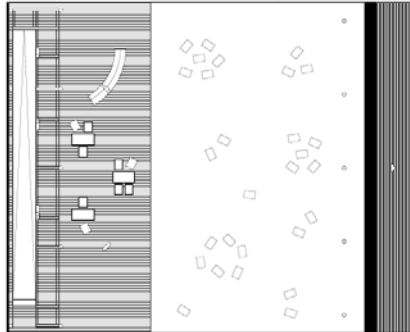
Planta do piso térreo do pavilhão proposto (esquema de esplanada).
